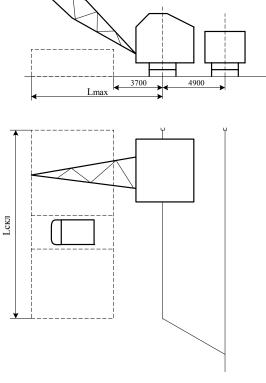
Поперечный разрез и план открытой площадки со стреловым железнодрожным краном
